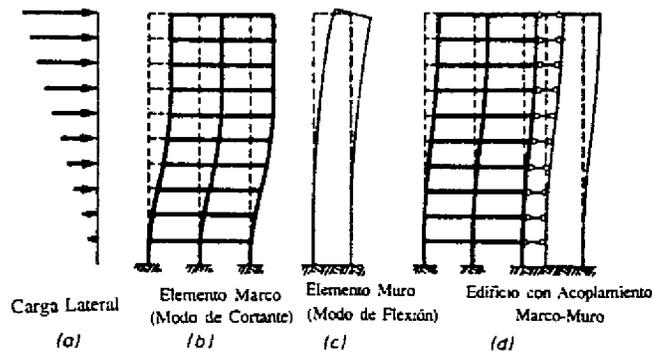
Patrones de deformación ante cargas laterales de un marco, un muro y un sistema mixto muro-marco
